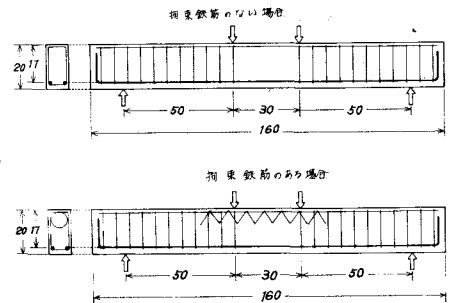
R.C.はり供試体寸法及び配筋状況 (単位: cm)
